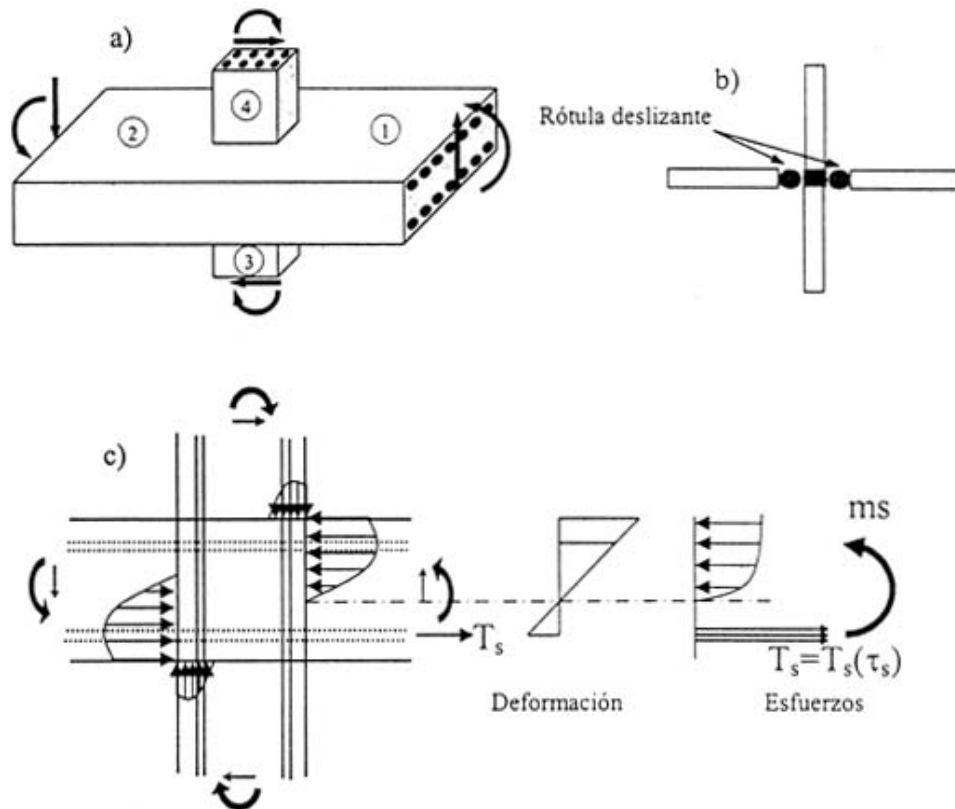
a) Junta interior viga plana-columna. b) Modelo de análisis. c) Distribución de esfuerzos y deformación en la sección transversal de la viga.
